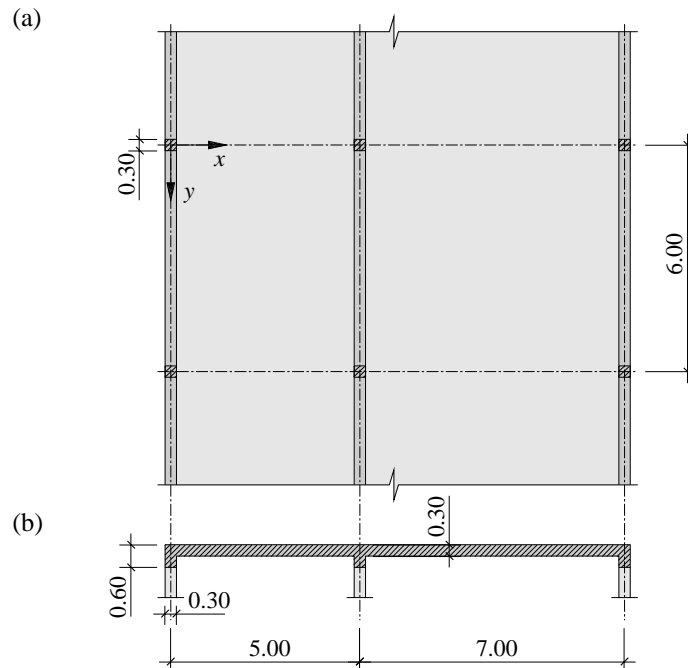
In Aufgabe 1 behandelte Stahlbetonplatte: (a) Grundriss; (b) Längsschnitt. Abmessungen in m.
